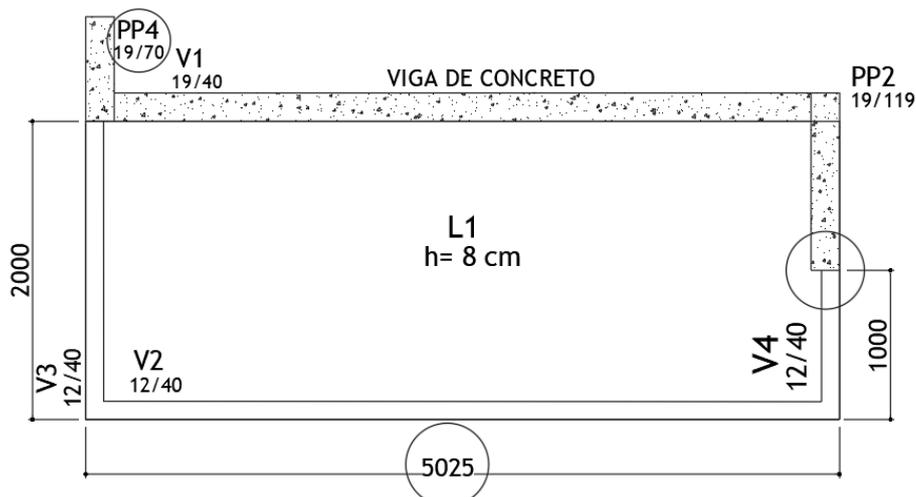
Planta baixa da marquise em concreto dimensionada no TQS
